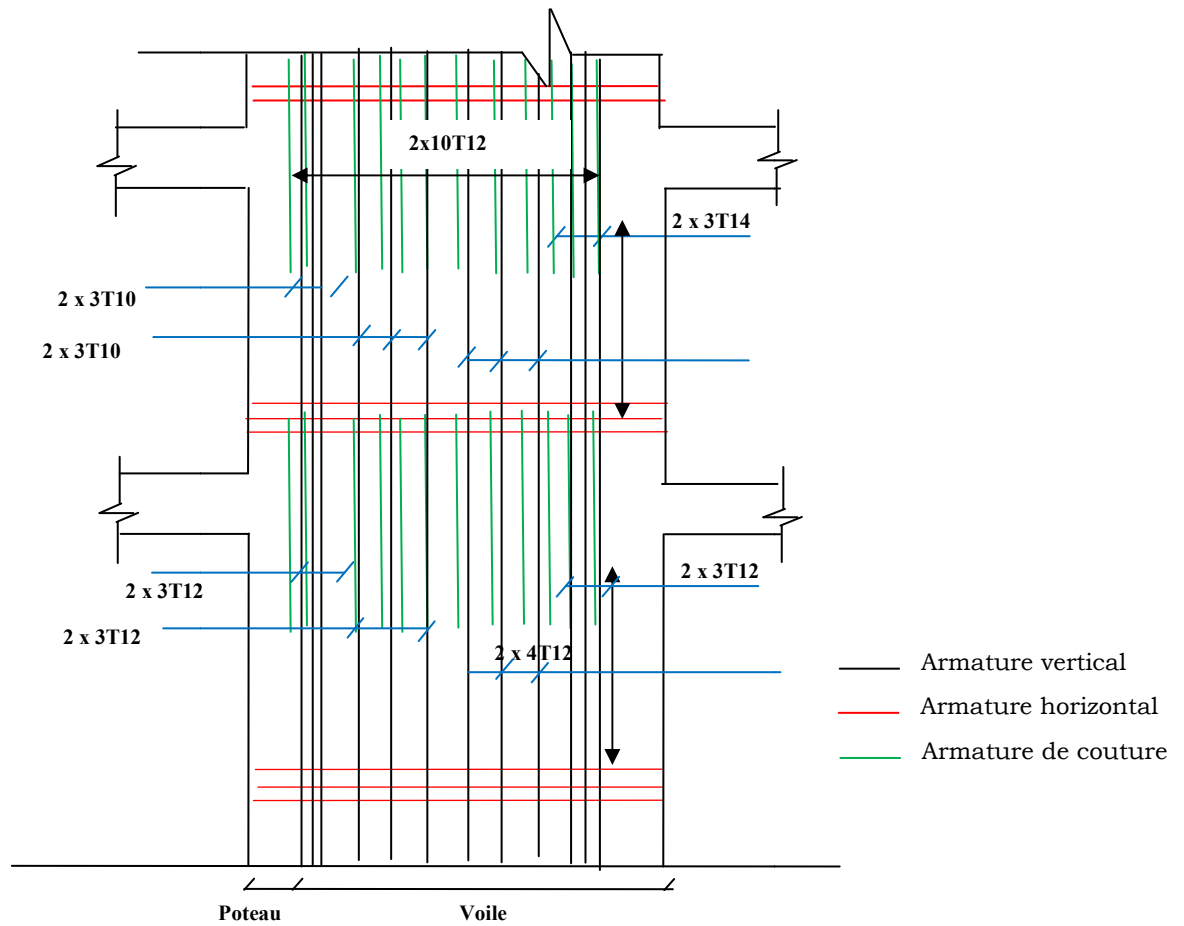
Détail De Ferraillage bout de Voile 1 en élévation
